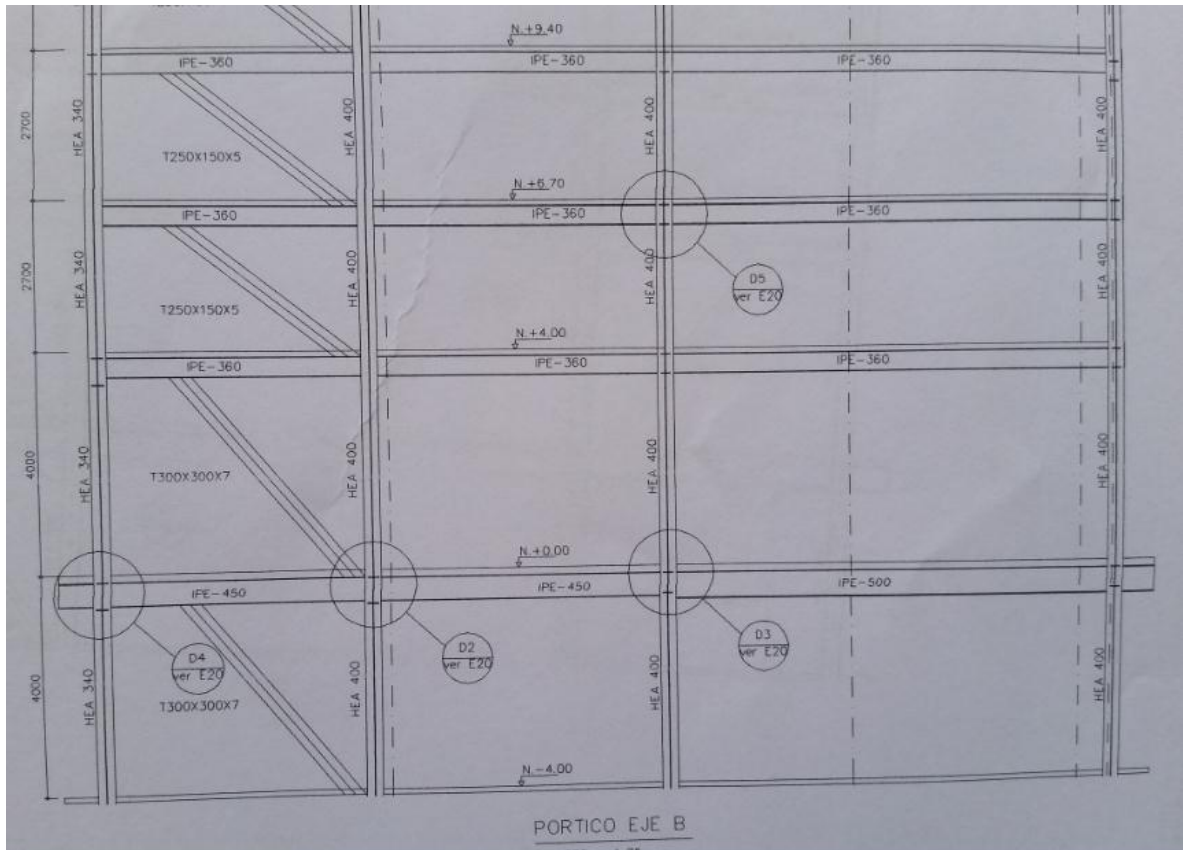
PLANTEAMIENTO DISEÑO ESTRUCTURAL DE ALZADOS Y PORTICOS CON MUROS ESTRUCTURALES PROYECTADOS INICIALMENTE.
